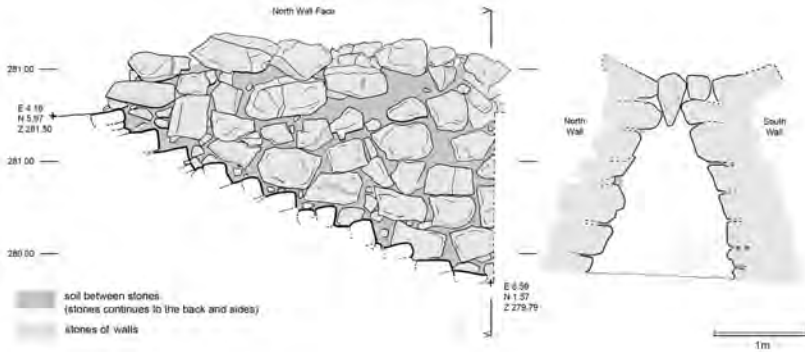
Profil und Schnitt des Tunnelleinganges
